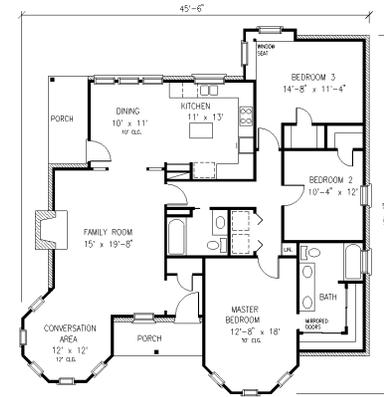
Ejemplo de *Esquema motivado* con un plano arquitectónico de una edificación.
